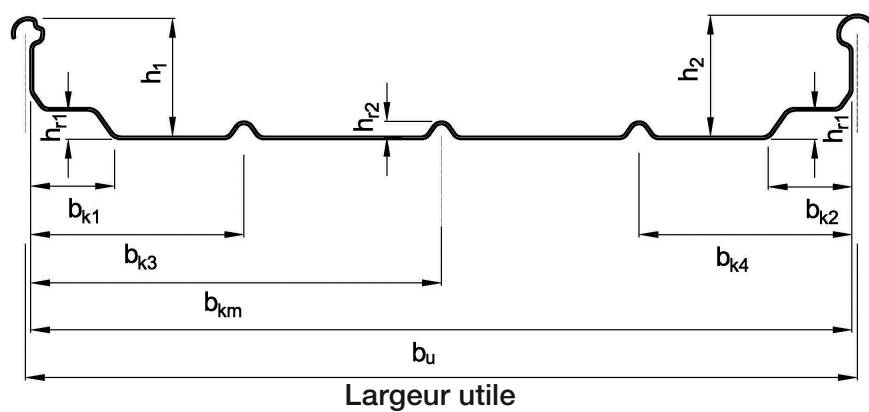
Section transversale des profilés à joint debout – type 2
